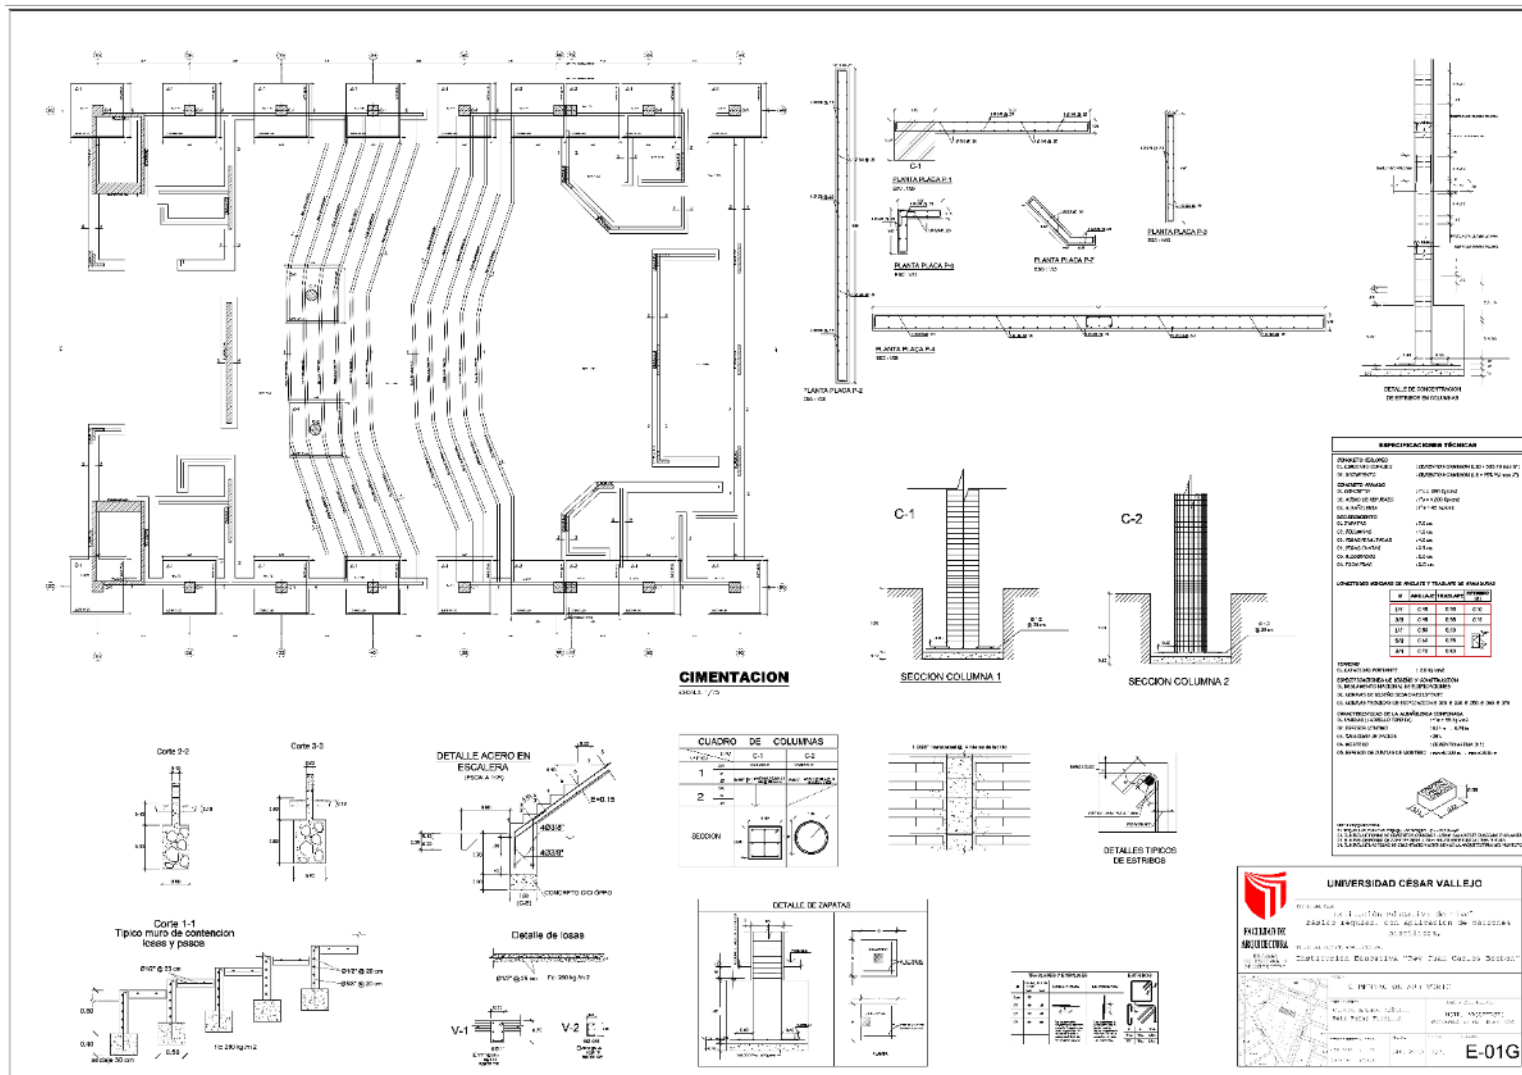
Plano de cimentación bloque "G", Fuente: elaboración propia
